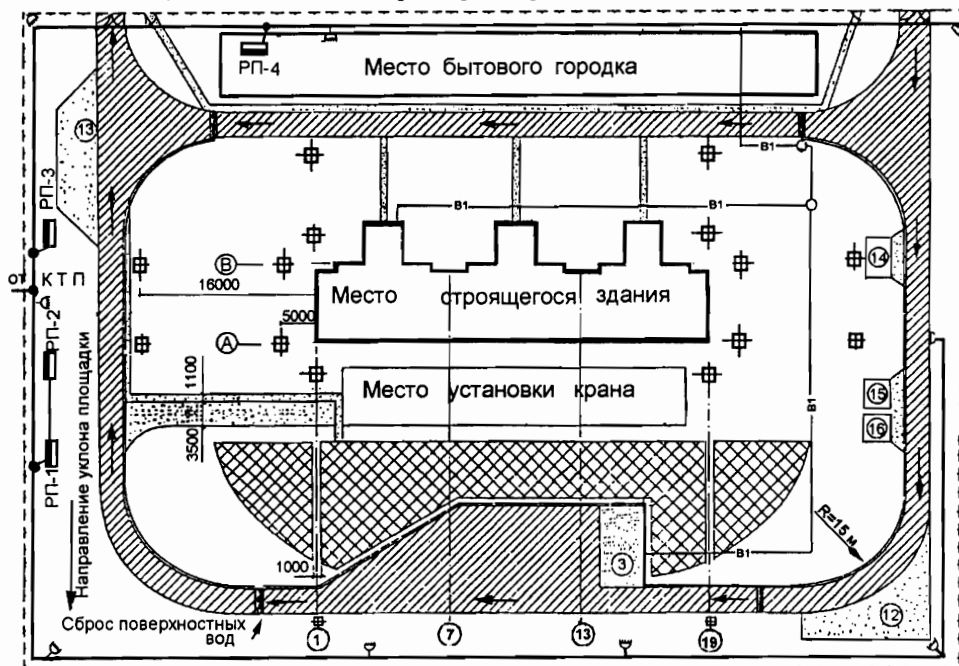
Стройгенплан на подготовительный период возведения здания
